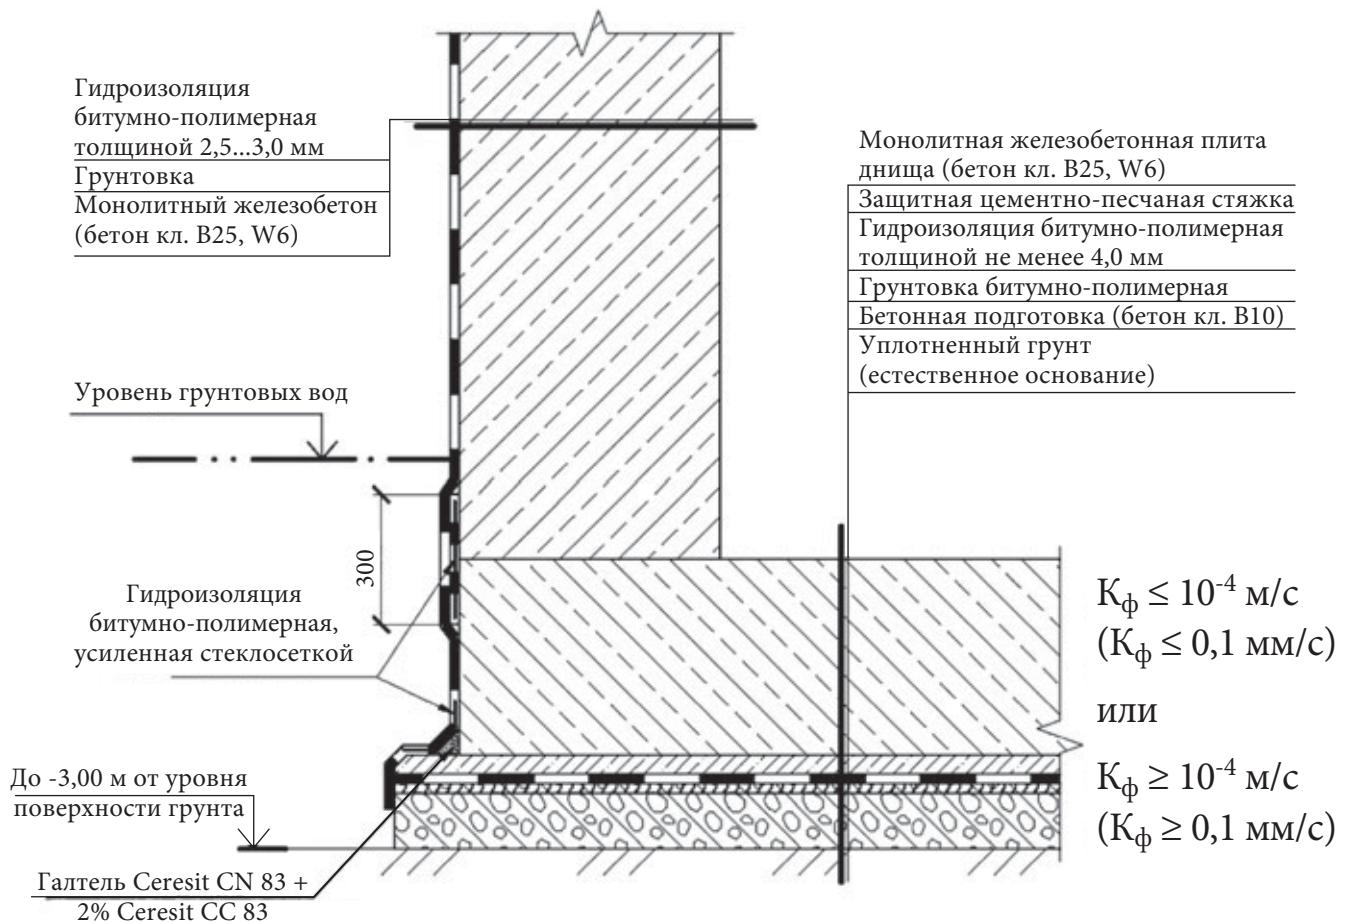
Гидроизоляция бетонных плит оснований и стен подземных сооружений в условиях воздействия грунтовой воды под давлением
